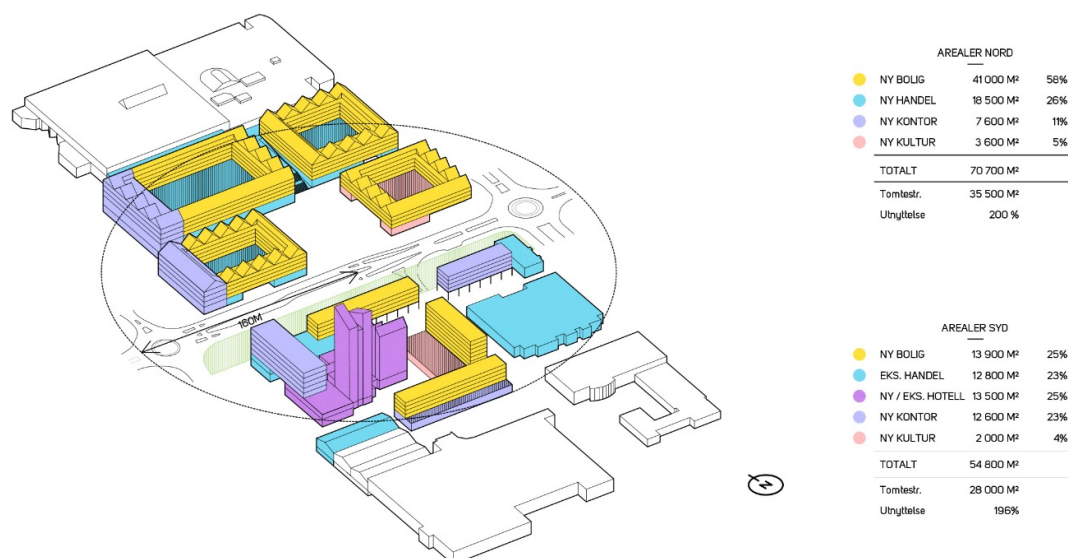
Dagens handelsarealet tetttest opp mot kollektivknutepunktet.
